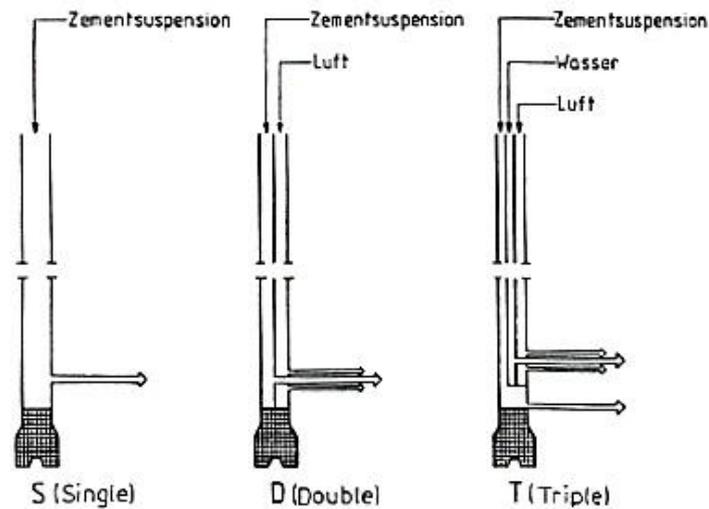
Soilcrete-Düsenstrahltechniken S,D und T [3]
